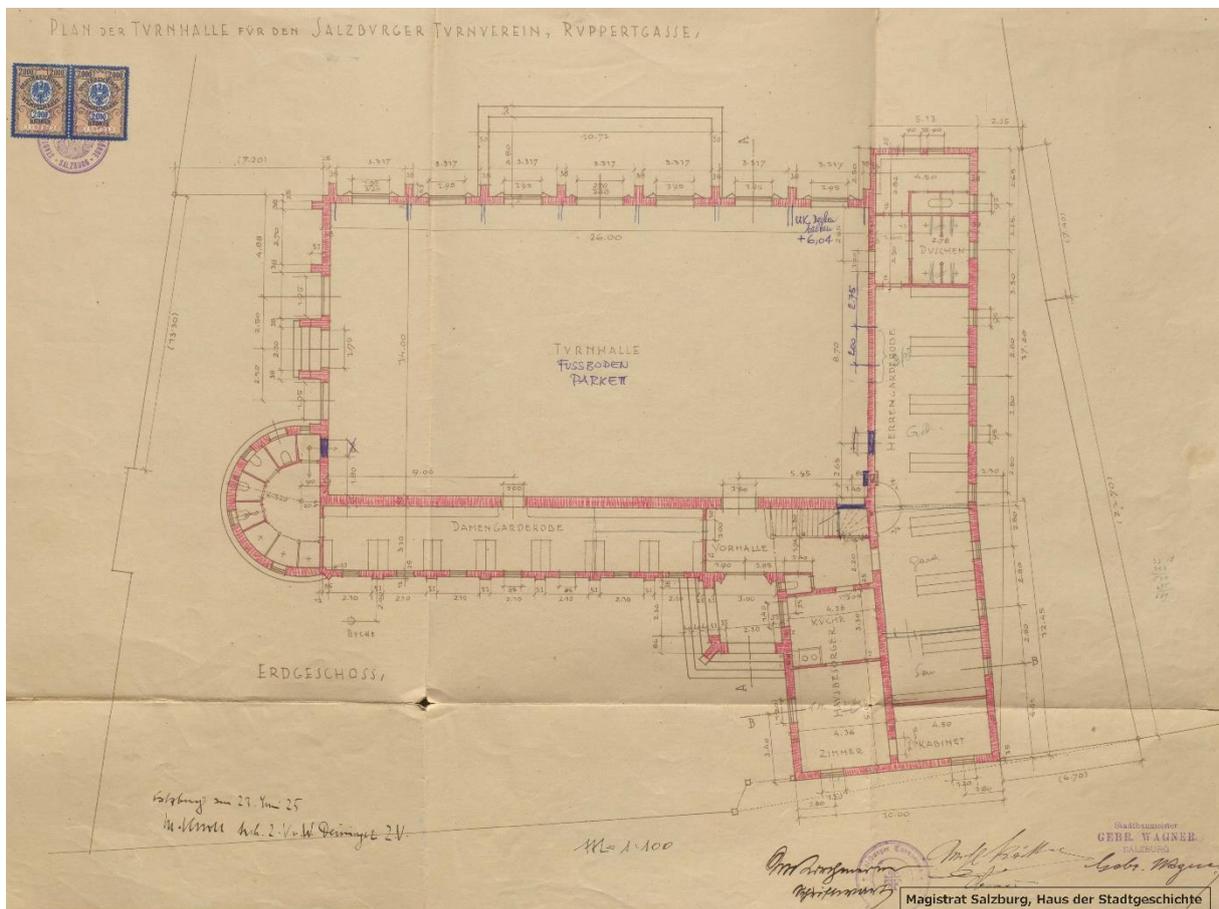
Einreichplan EG 1925 © Architekt Daininger und Stadtbaumeister Gebr. Wagner
